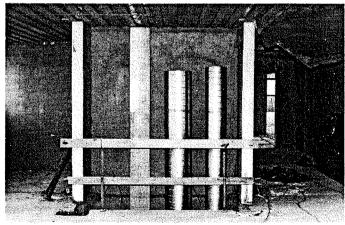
Øverste del af installationsskakten bag trappenkernen, se etageplanen figur 3. pkt. 5.
